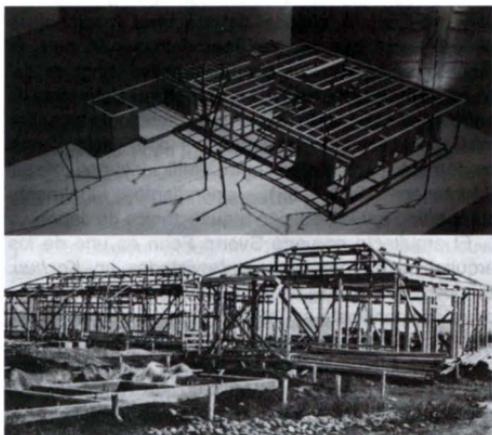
Comparativa entre la maqueta de la casa Schreiner de Sverre Fehn y la imagen de una casa tradicional japonesa en construcción publicada por Tetsuro Yoshida en la edición inglesa de *Das japanische wohnhaus* de 1955.
